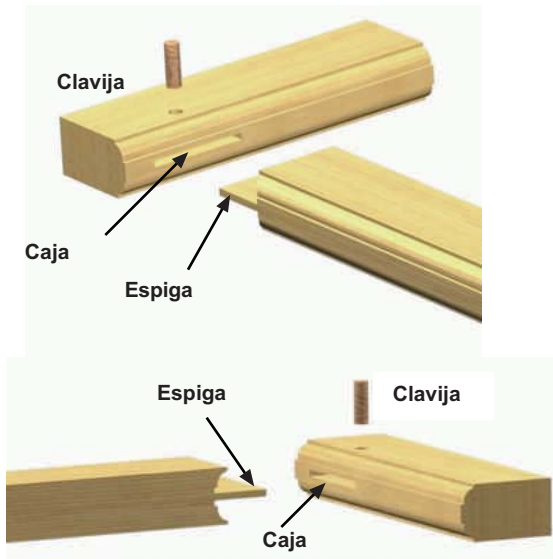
2: Piezas del bastidor de la puerta con unión llamada caja y espiga.
